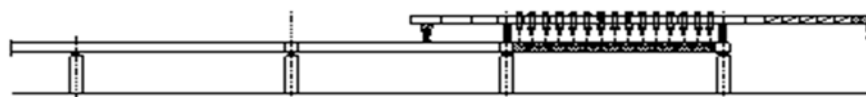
スパンバイスパン工法（SSM）の施工ステップ
